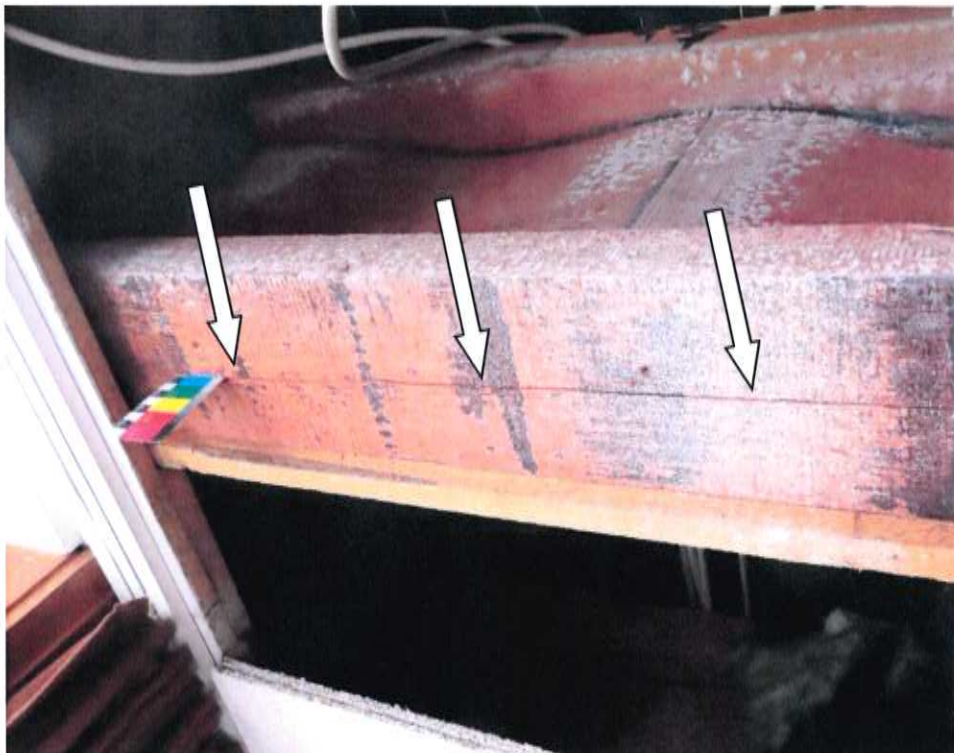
Holz-Wellstegträger: Untergurt mit Längsriss im Auflagerbereich
